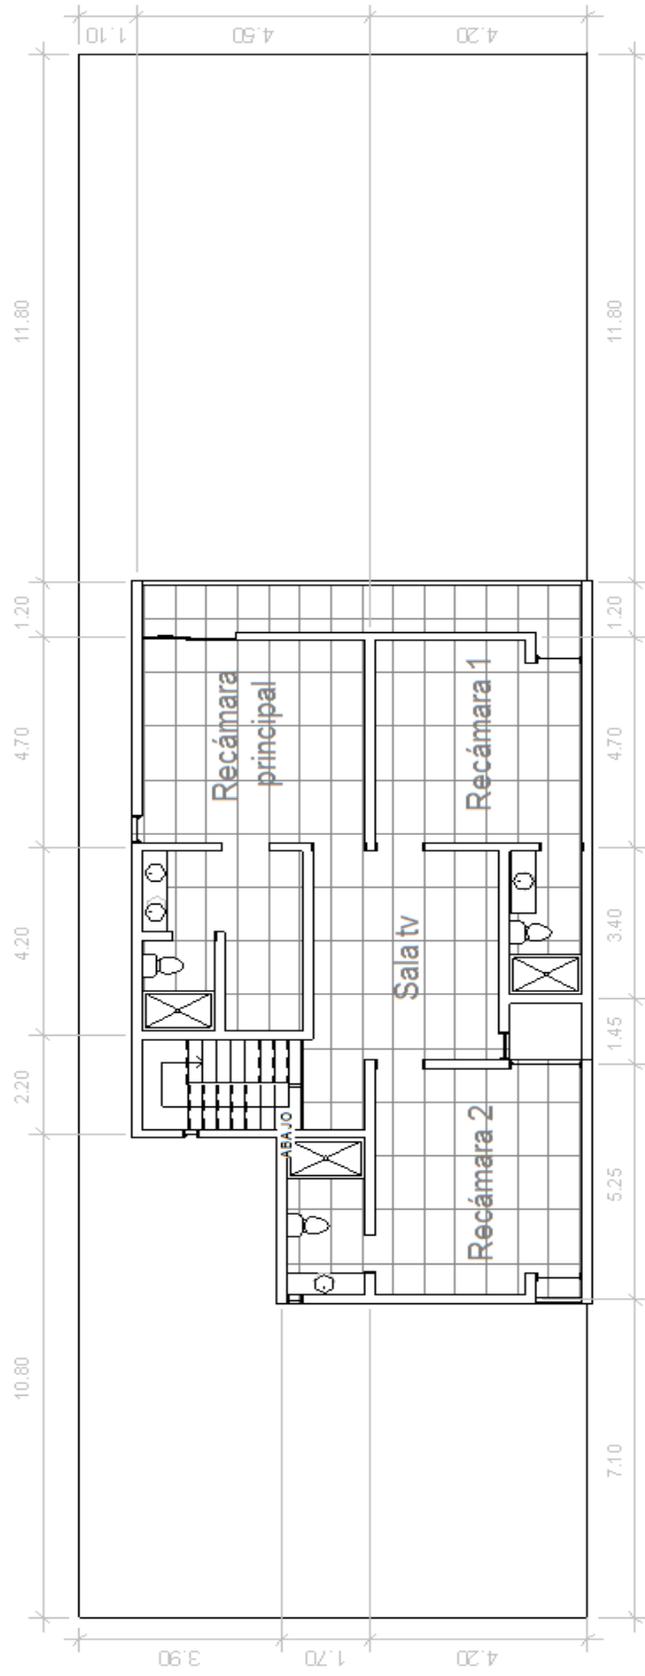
Croquis de planta alta de vivienda tipo residencial plus
